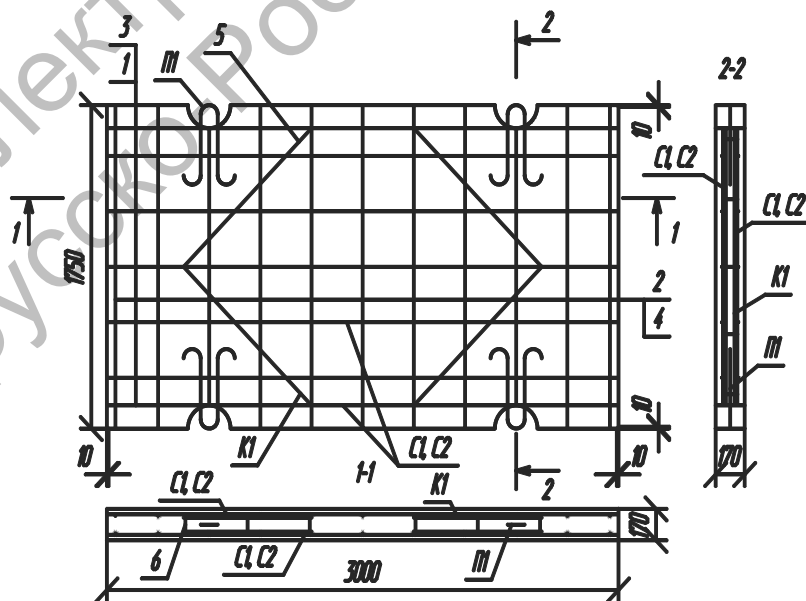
Опалубочные чертежи и схемы армирования железобетонных плит для покрытий автомобильных дорог марок 1ППЗ0.18-30, 2ППЗ0.18-30
